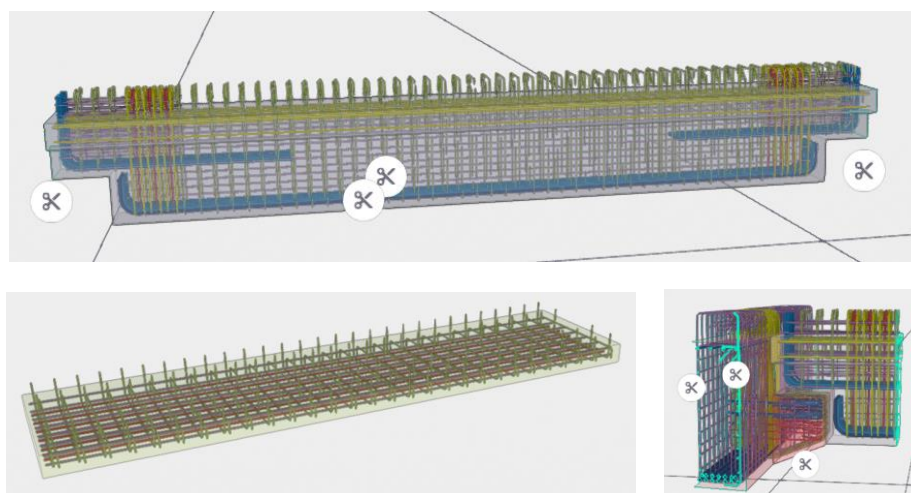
Modelação das armaduras das vigas, pré-lajes e cachorros da cobertura.
